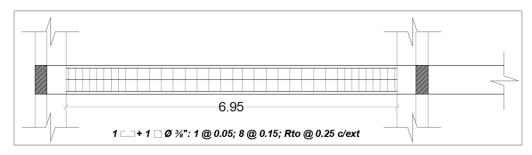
Sección de viga en aulas de 60cm. de peralte.
